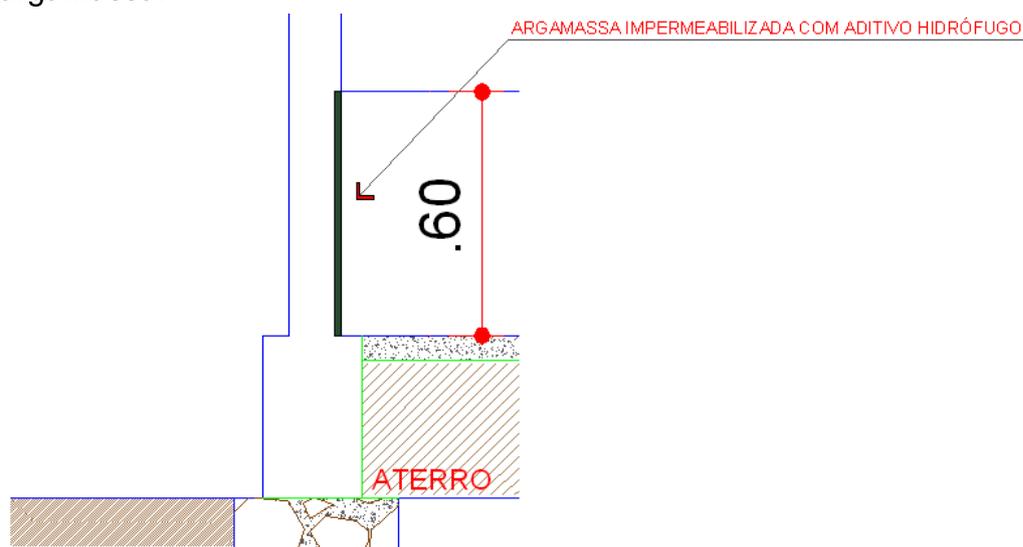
Detalhamento da impermeabilização das paredes internas com revestimento impermeabilizado com aditivo hidrófugo (1,0cm. < e < 2,0 cm).
